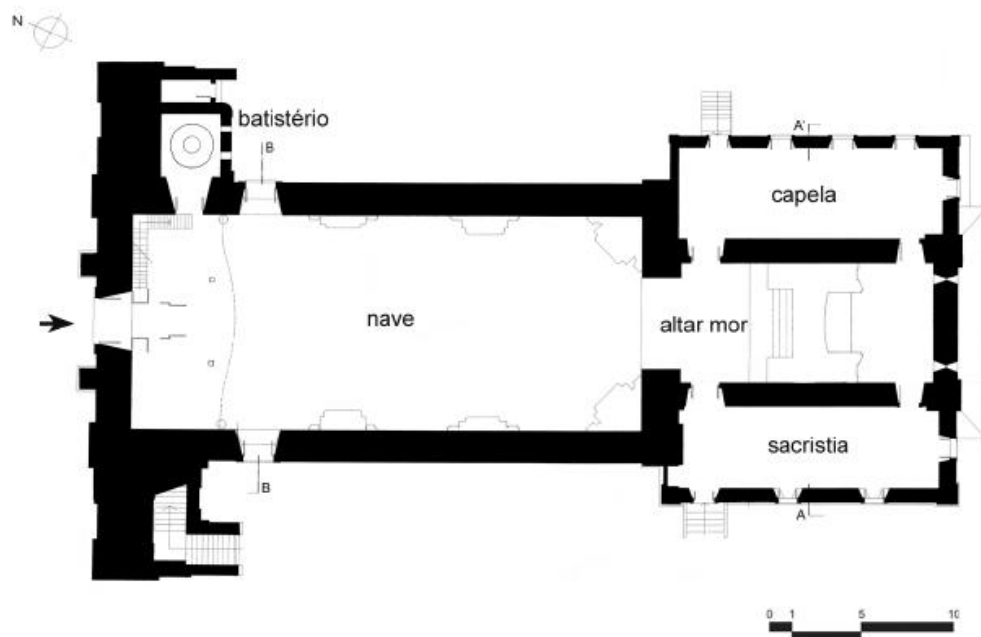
Planta Baixa da Igreja Matriz de Viamão. Fonte: Arquivo do IPHAN/RS. Edição: LEPAC.
